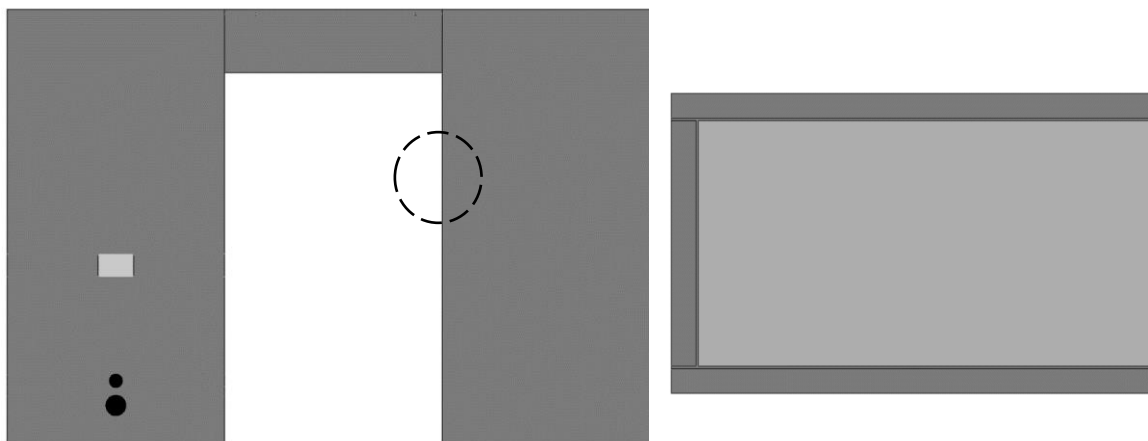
Disposição dos painéis sandwich com uma abertura, com pormenor da padieira e da ombreira.
